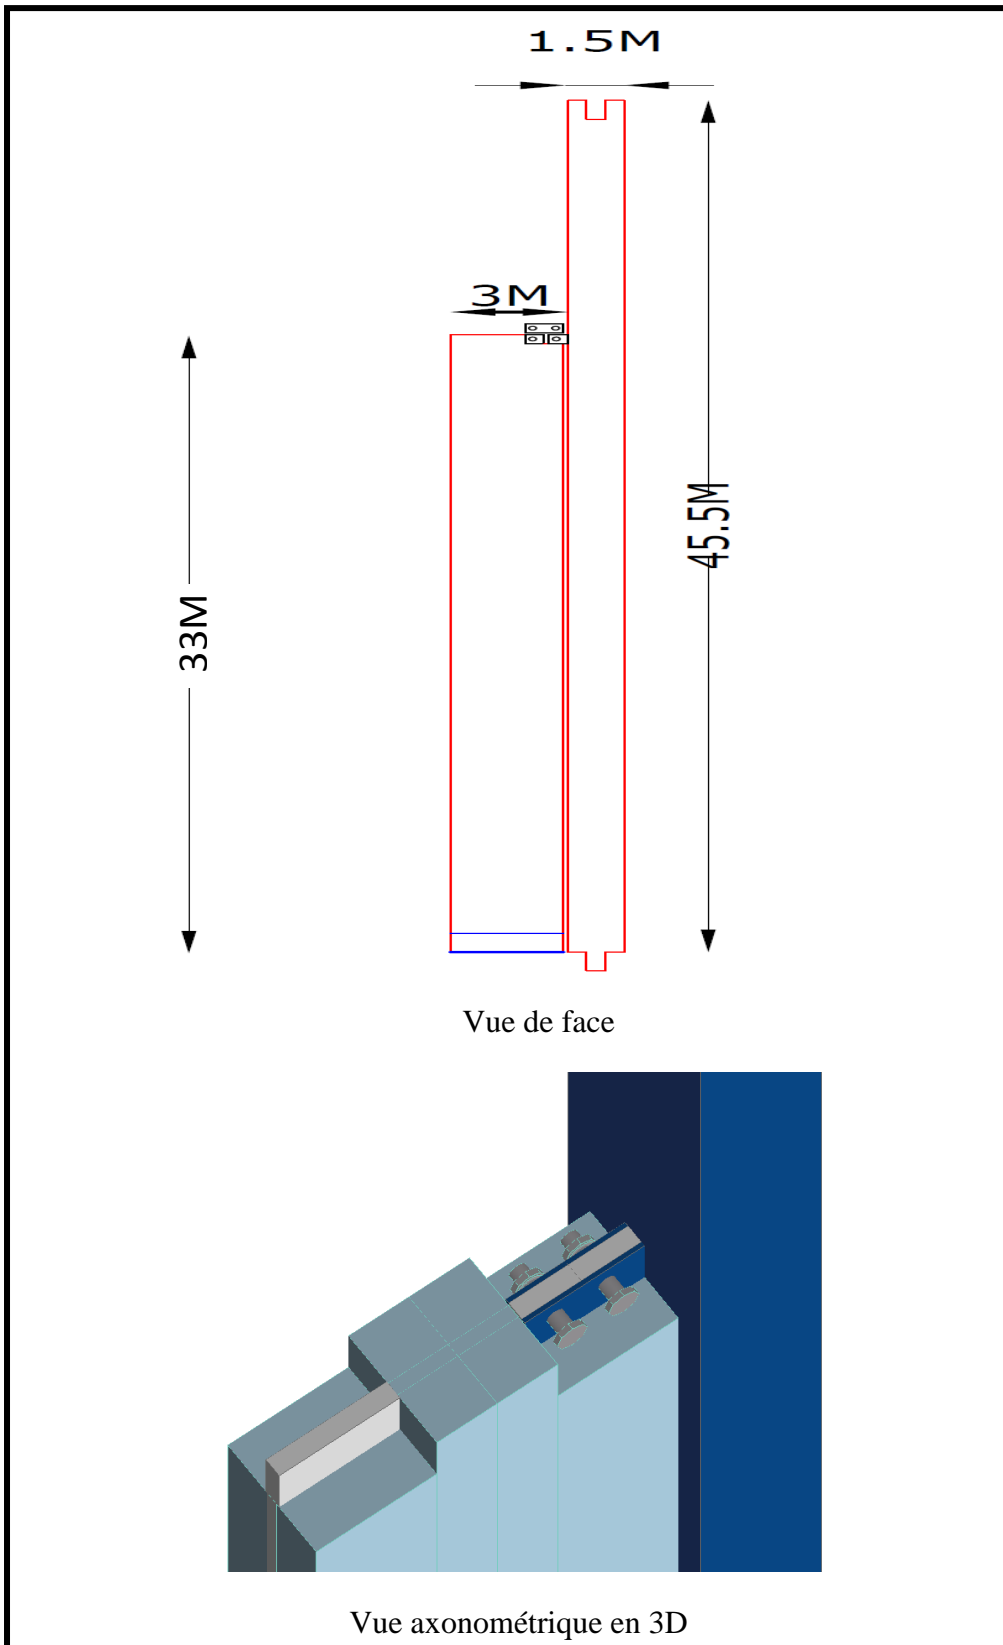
Assemblage d'un mur de partition avec un adaptateur de façade
